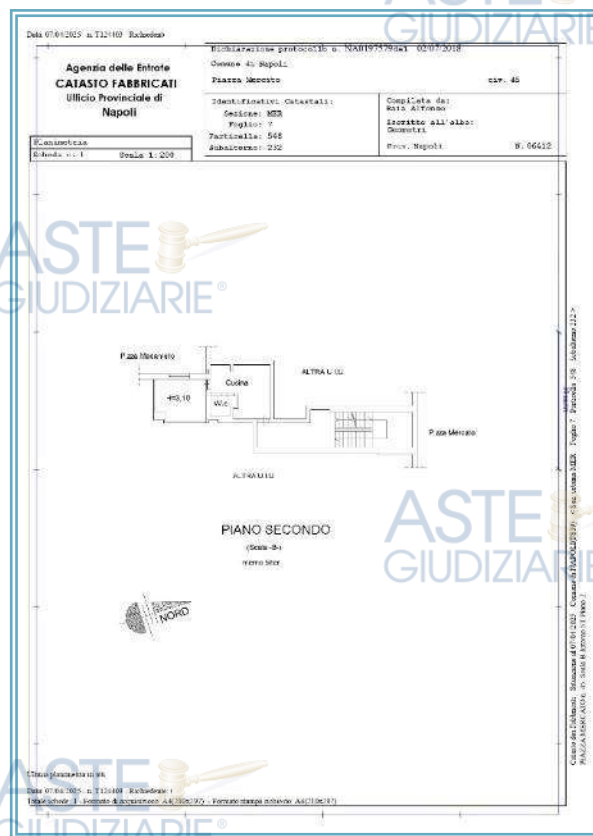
Pianta catastale attuale – Piano Secondo (LOTTO 8a)
